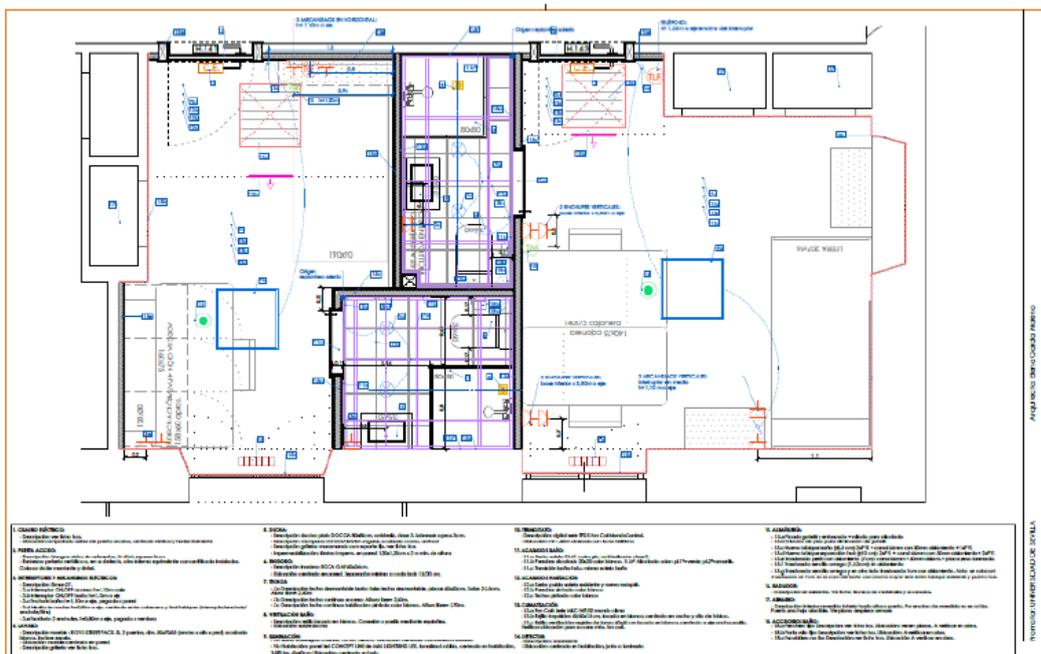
Plano de acabados Hab 141/143. Fuente: Archivo Proyecto de reforma de las Estancias de la planta 1ª y 2ª del CMHC Arquitecta Elena García Moreno.
